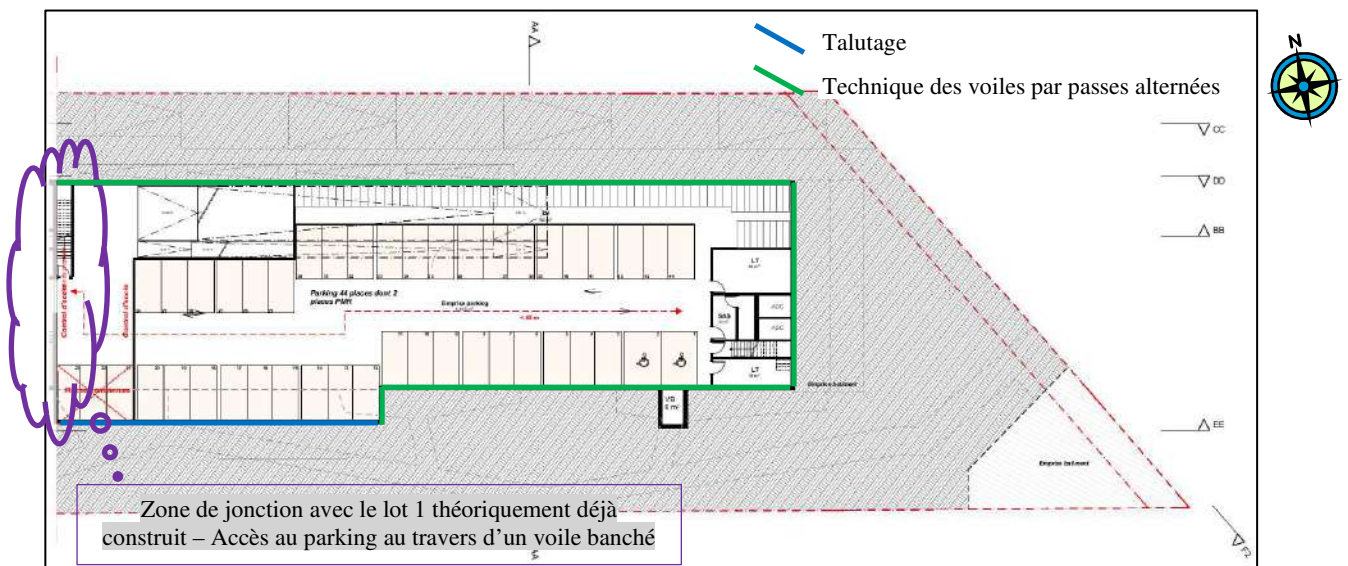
Plan des techniques de soutènement sur fond de plan du sous-sol du projet
